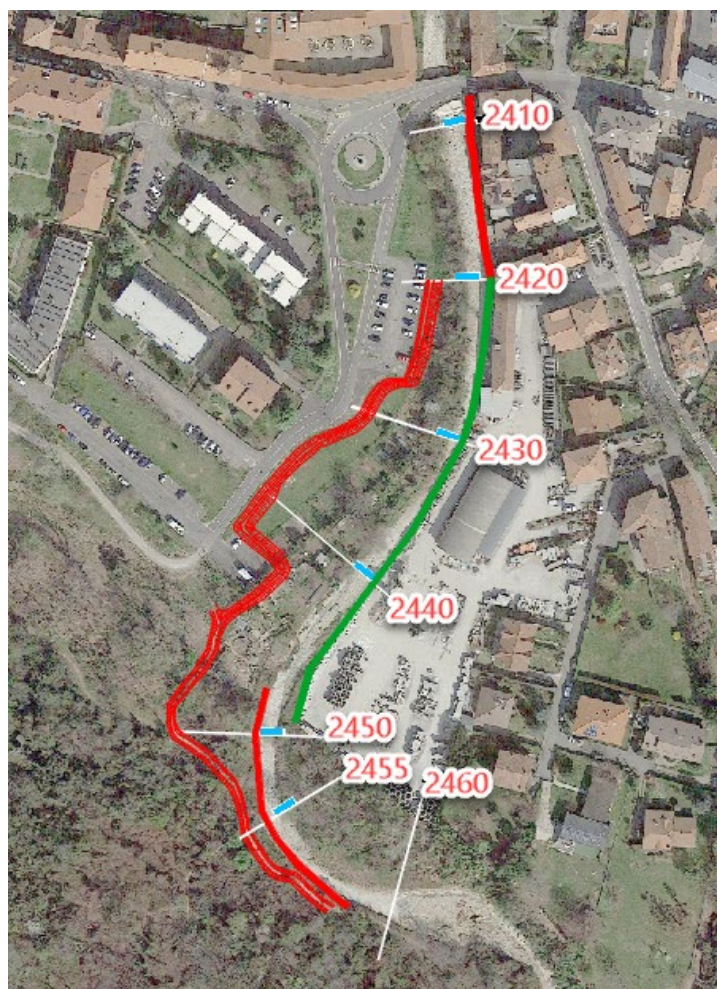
STRALCIO CARTOGRAFICO DELLA PLANIMETRIA DI PROGETTO
